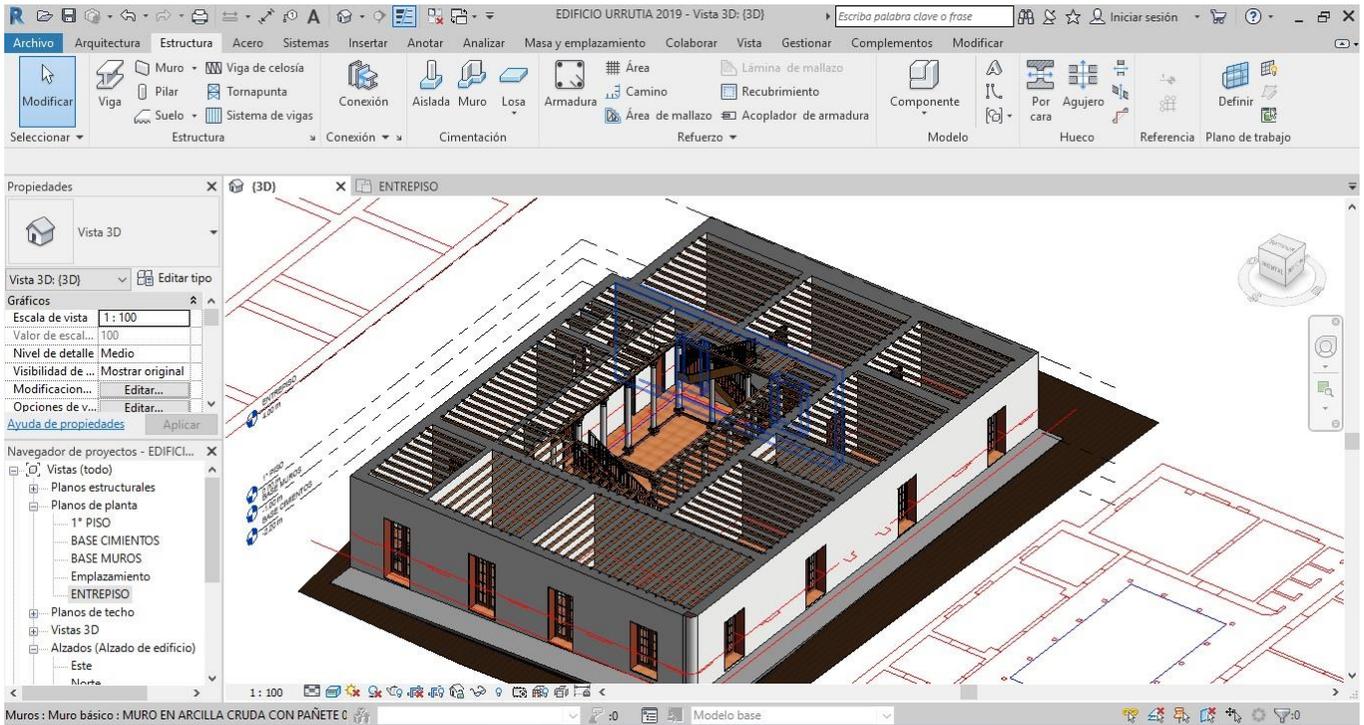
Sistema de vigas para placa de entrepiso. (14)
